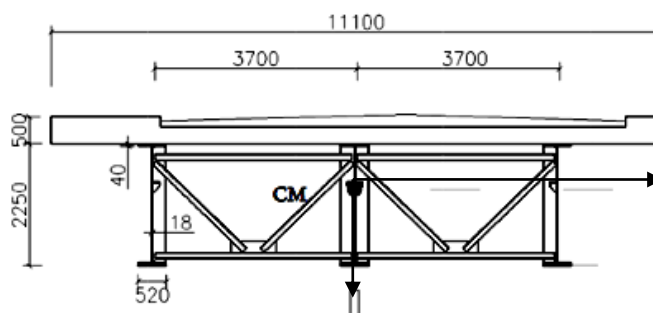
Rappresentazione sezione impalcato in acciaio
